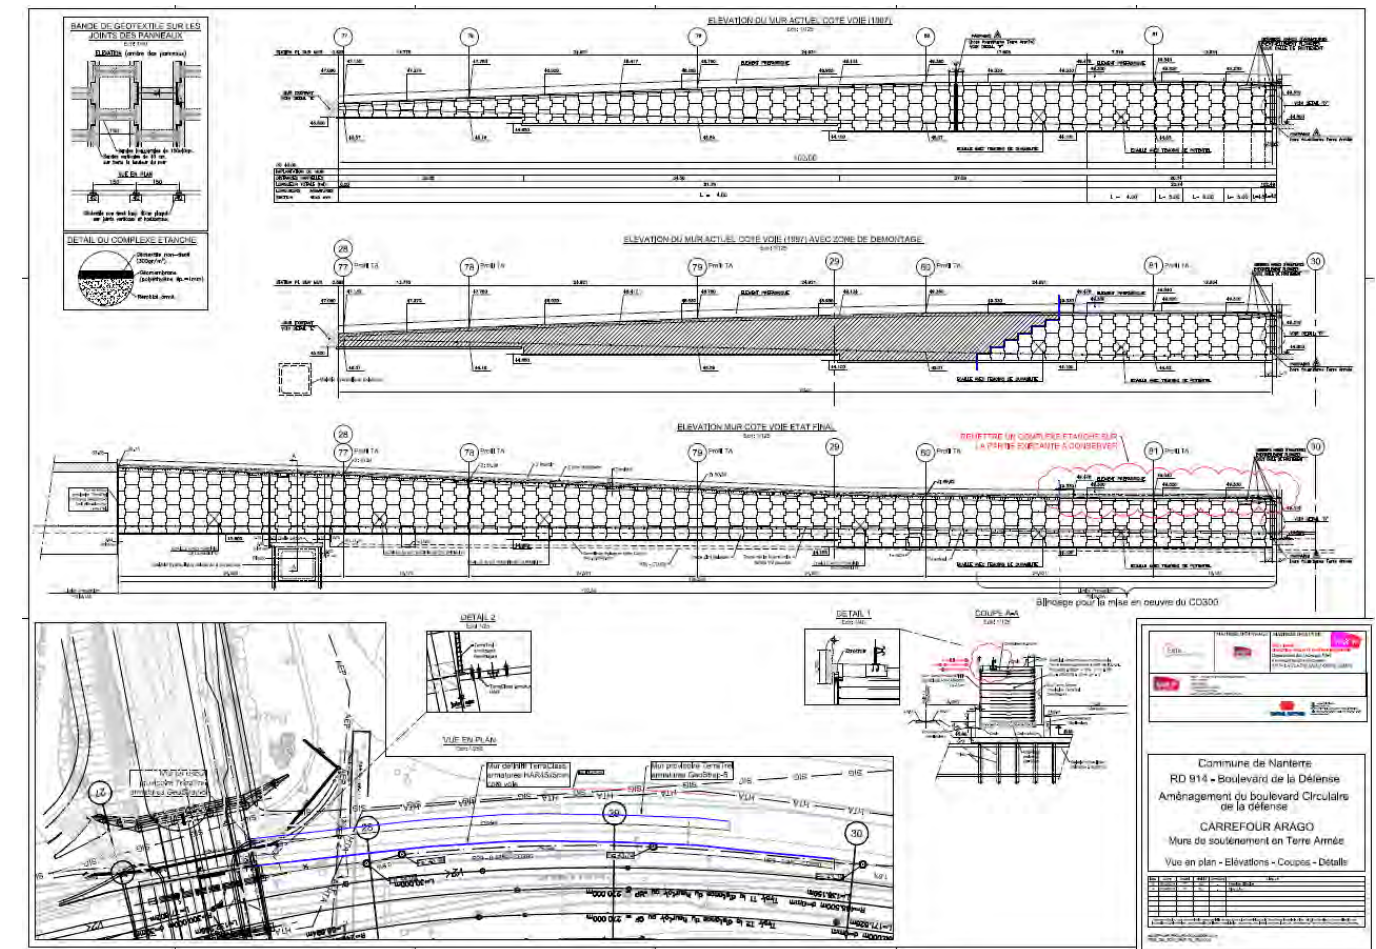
Murs de soutènement en terre armée : vues en plans - élévations – coupes – détails
